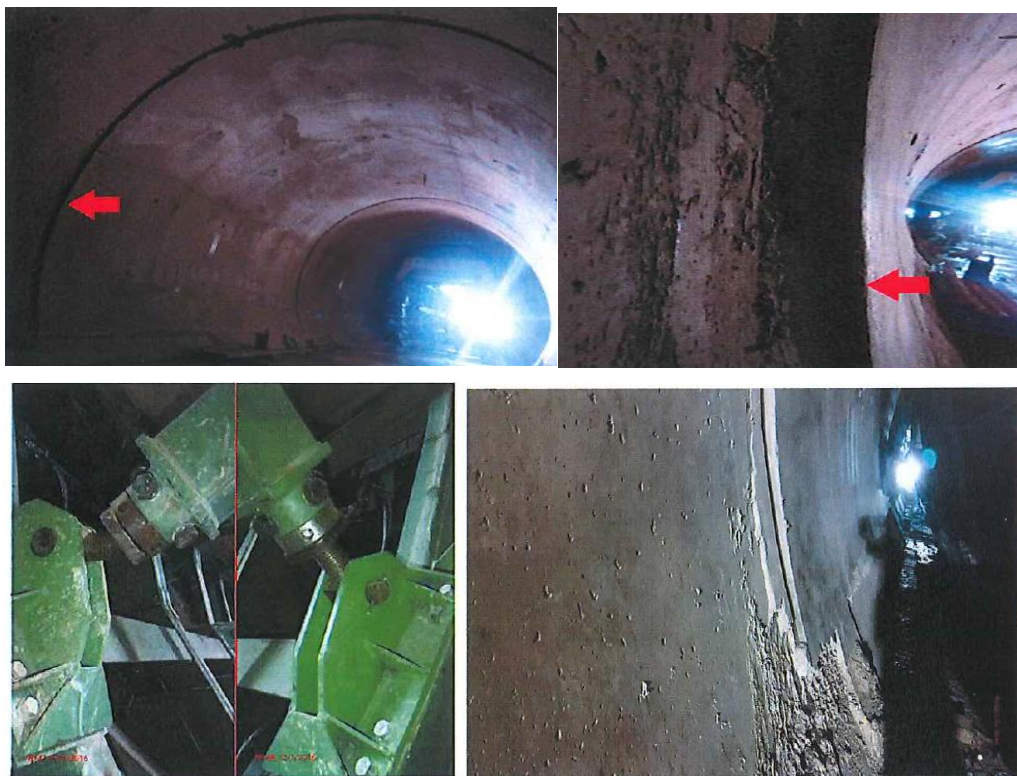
Vista de la observación al muro guía construido en el tramo del túnel
